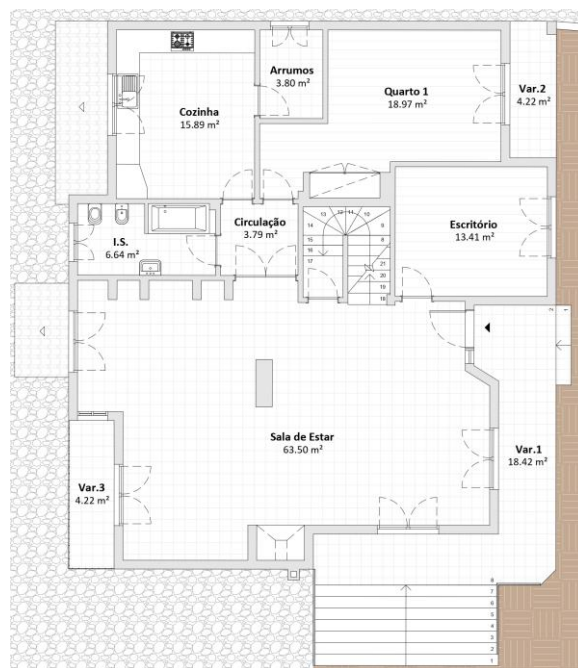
Existente - Planta do piso 0. Fonte: Garq / Desenvolvimento: Autora.
